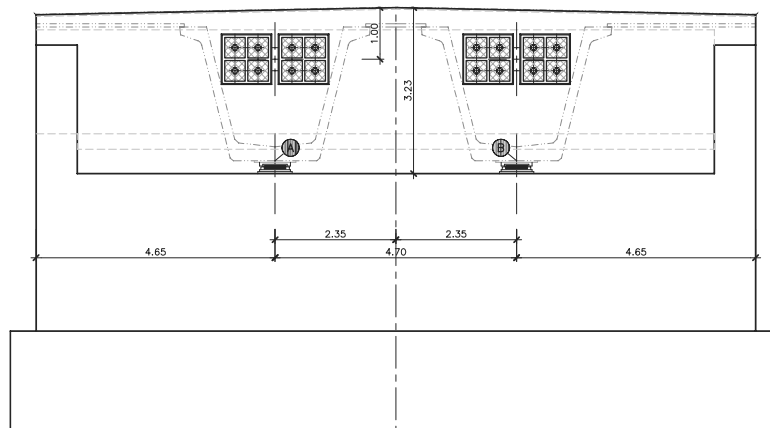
Estribo fijo de tablero de vigas prefabricadas continuas
